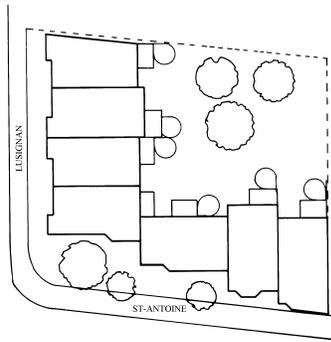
Le Carré Saint-Antoine : plan du site.
